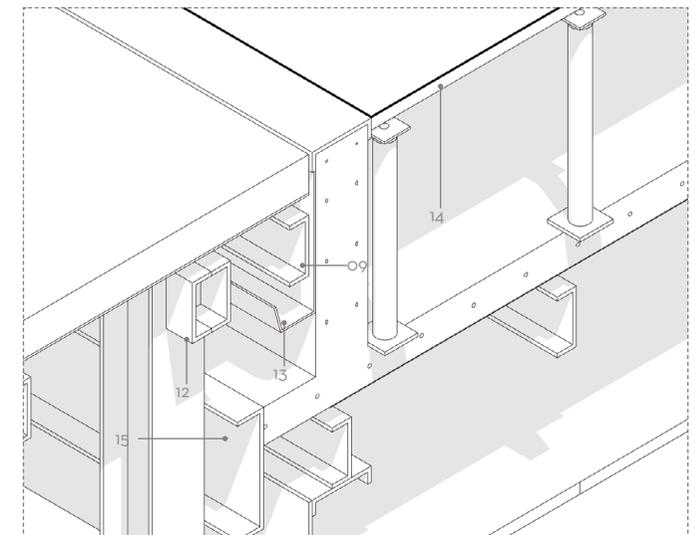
Axo_05. Junta entre Losa de vestibulo exterior y losa de piso técnico (Longitudinal)
